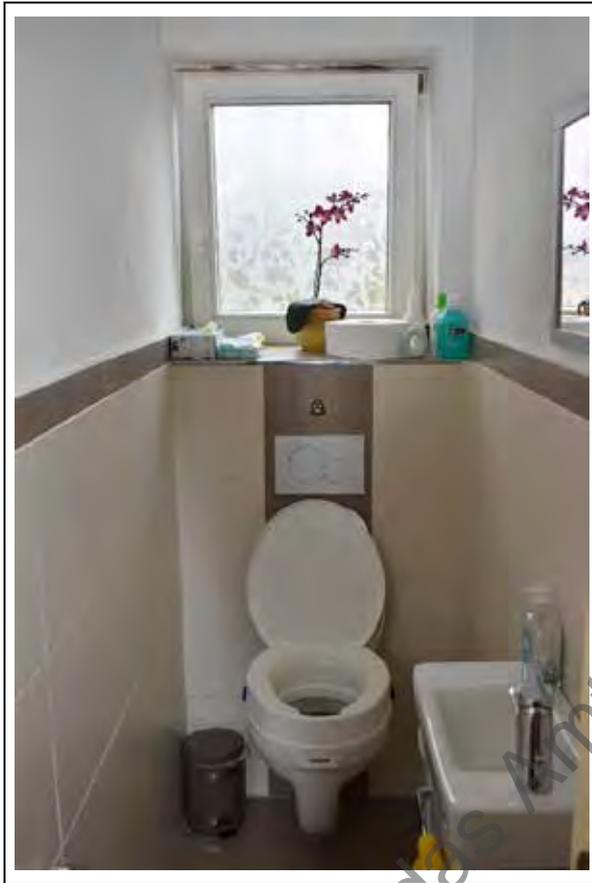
Wohnhaus, EG, WC, Unterschrank unter Waschbecken
